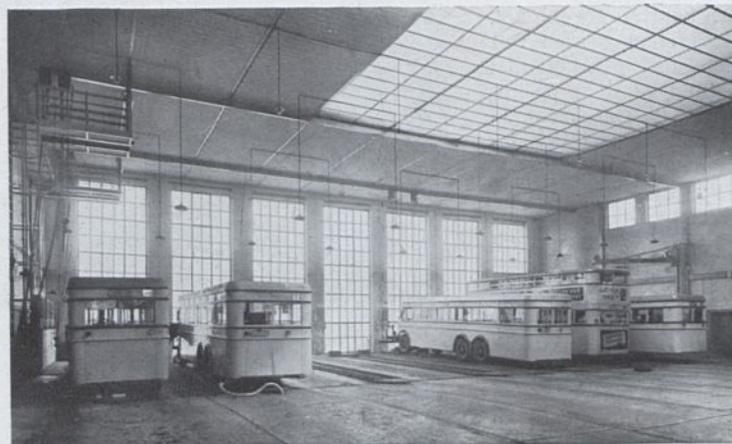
Halle II. Reparaturstände mit Krananlagen.
